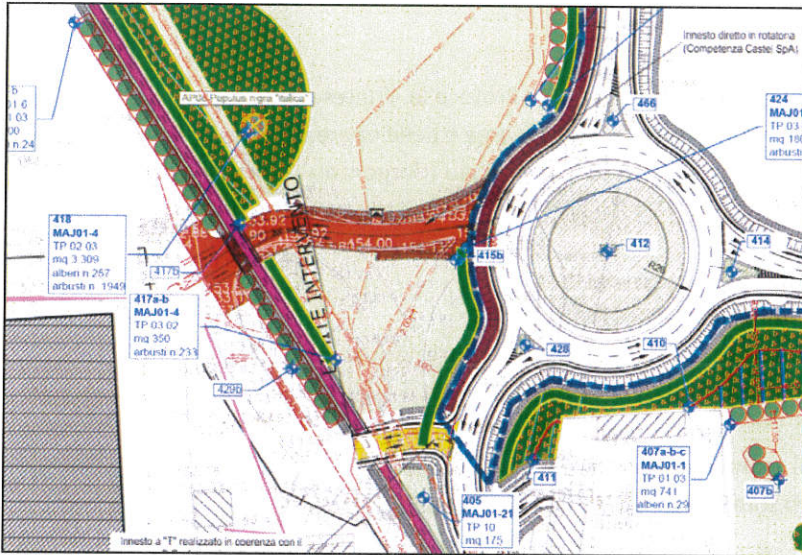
MODIFICA TECNICA- PLANIMETRIA AREA DI INTERVENTO CON NUOVO ACCESSO ALLA DITTA CASTEL
